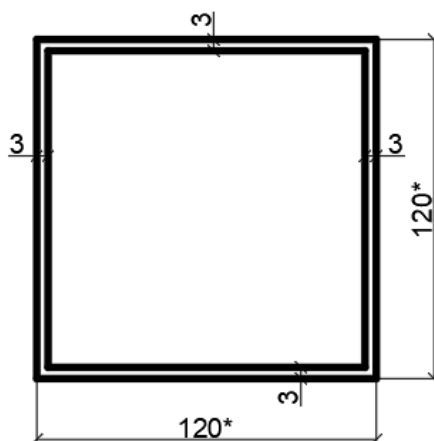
Фактическое поперечное сечение нижнего пояса е-5 стропильной фермы
